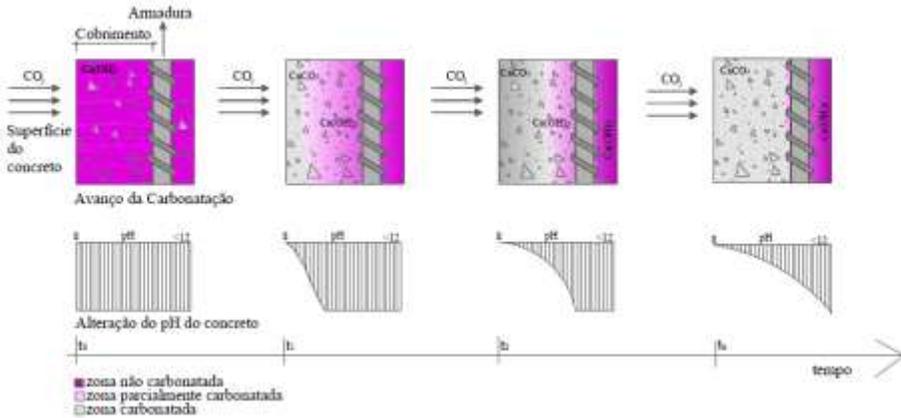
Vida útil das estruturas de concreto armado, quando degradadas por corrosão
